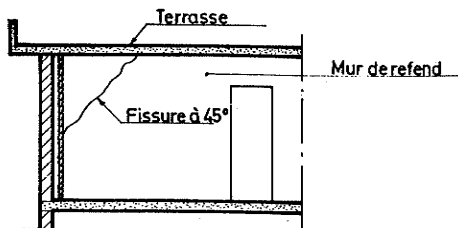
Les murs intérieurs et cloisons subissent l'entraînement du plancher-terrasse.
